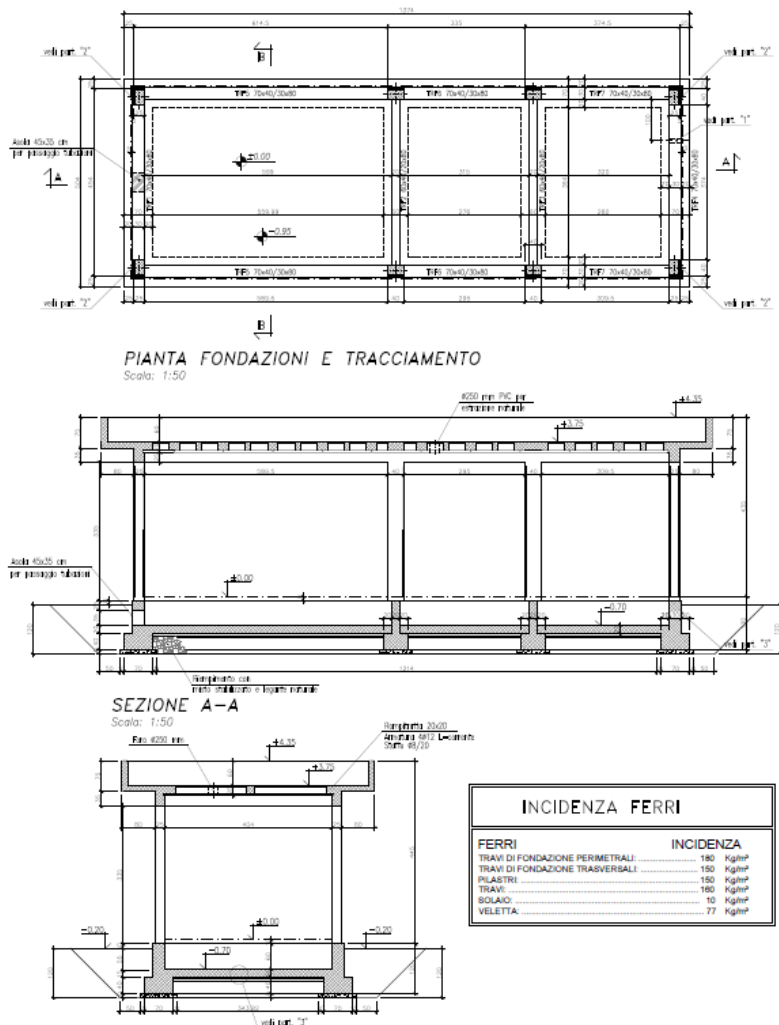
Progetto in variante - fabbricato FAVE - Pianta, prospetti e sezione
